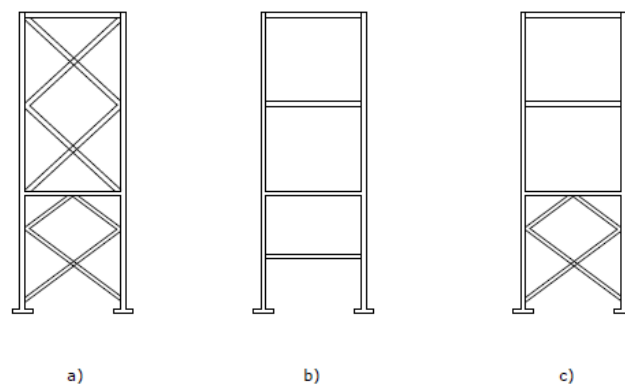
Tipos de torres, a) Reticulada, b) Pórtico, c) Combinación reticulado-pórtico
